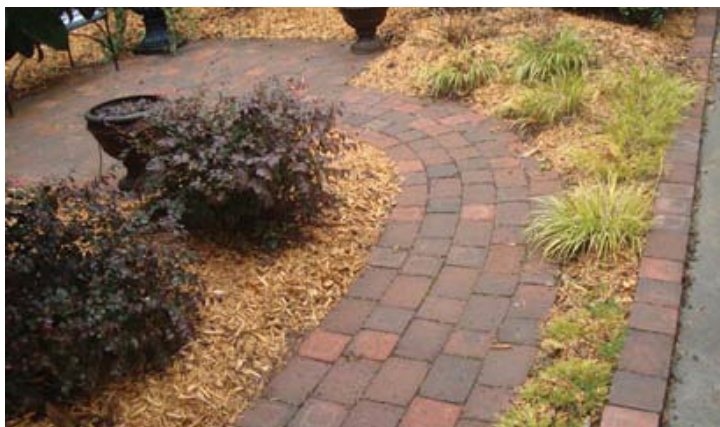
Esempio di percorso pavimentato con piastrelle; fonte: BRODA, 2011
